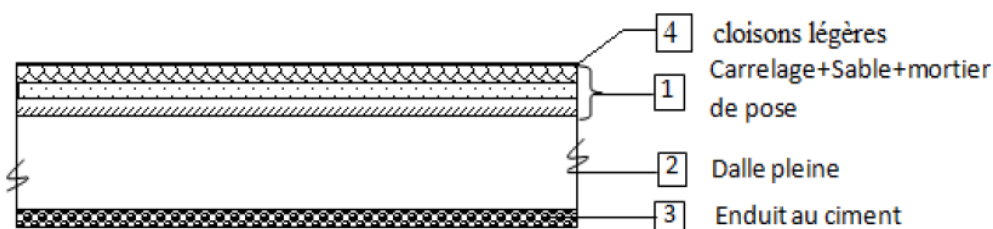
Coupe transversale d'un plancher à dalle pleine.
